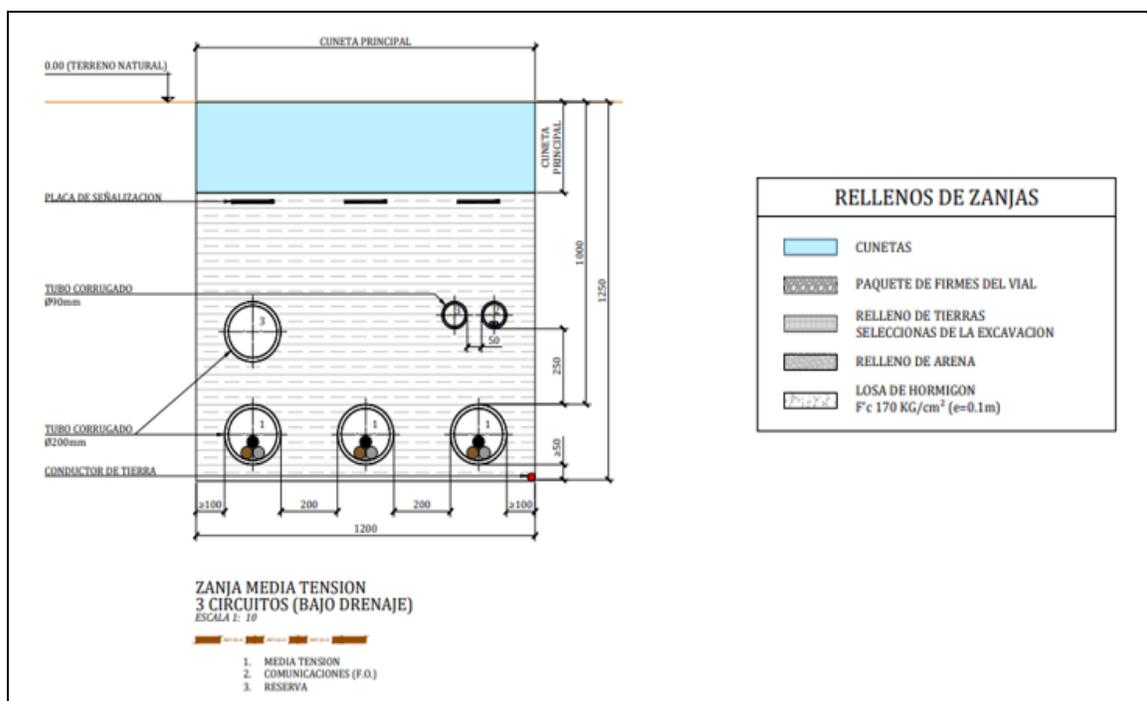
23 –Sección zanja media tensión bajo drenaje
